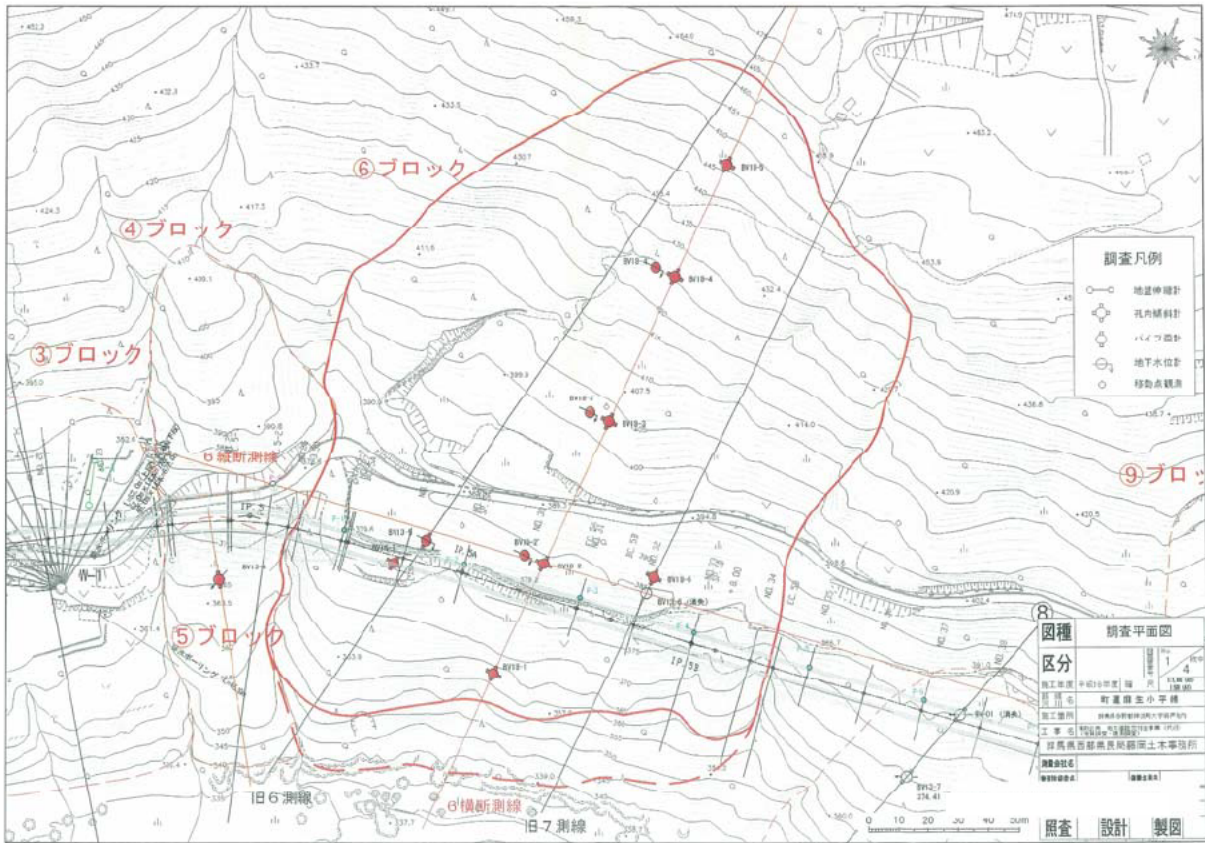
麻生小平地区平面図 (S=1 : 2500)
